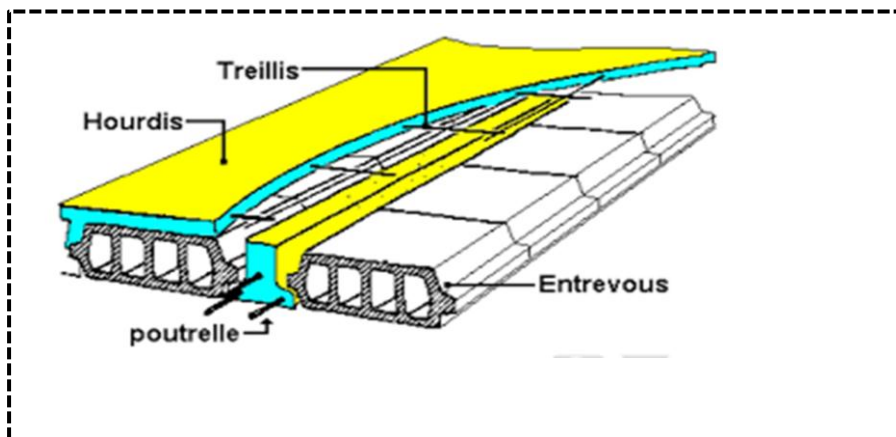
Vue sur la dalle corps creux. ,source : <https://www.goog:le.dz/search?>
